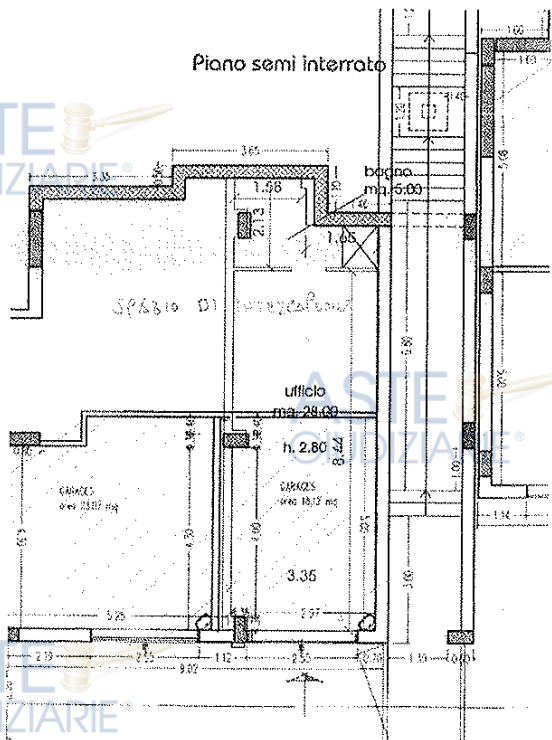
Piano semi interrato - sovrapposizione stato attuale con i disegni della Concessione edilizia
